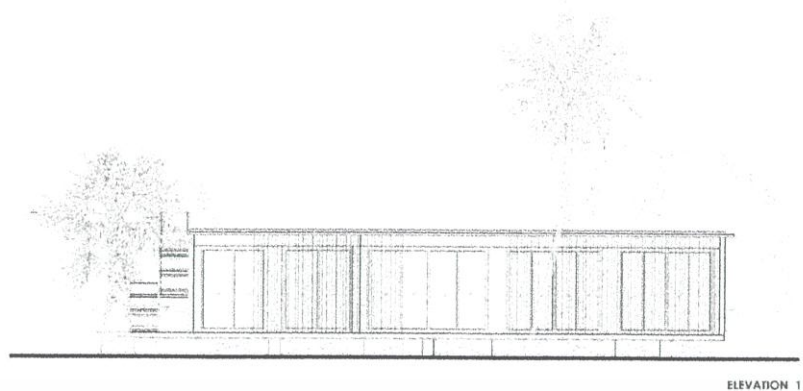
ผังโครงการบ้านพักตากอากาศ FLAT SCAPE HOUSE
